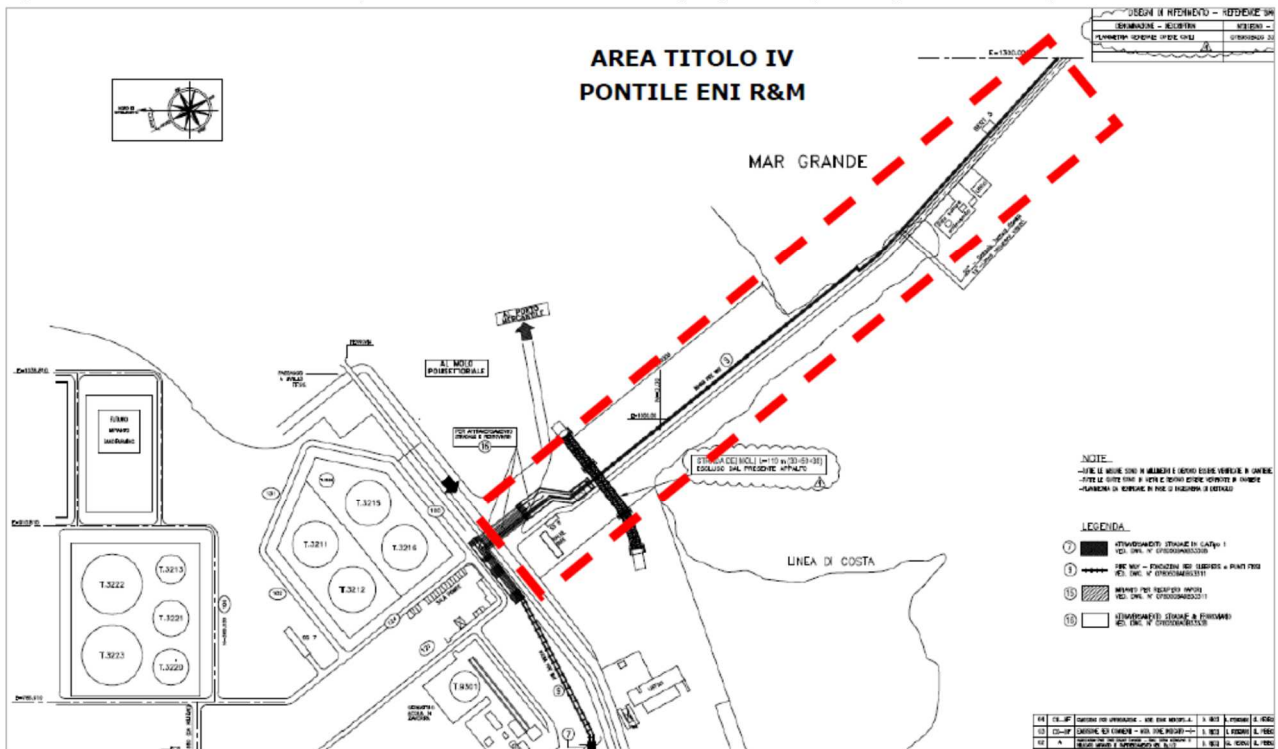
Planimetria area pontile offshore – stato di progetto – prolungamento del pontile
